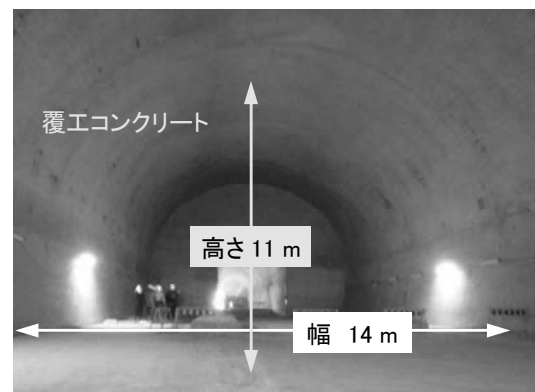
大断面トンネルの内観（NATM施工，二次覆工有）
